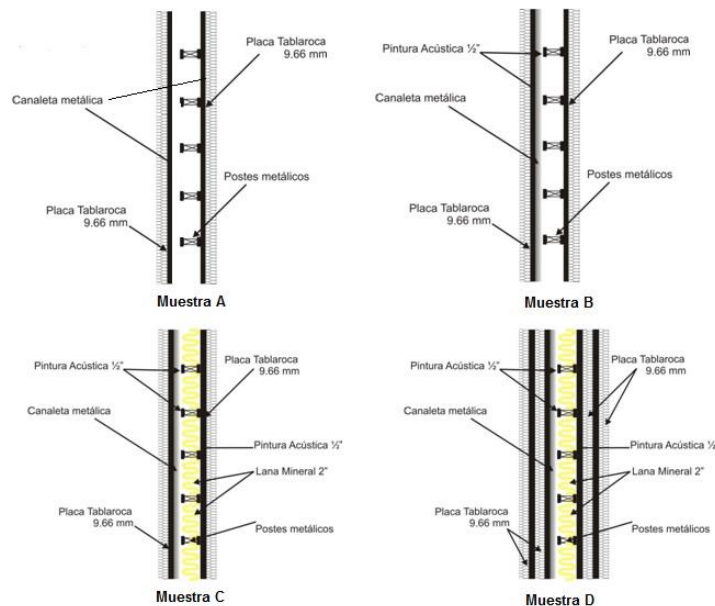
Detalles de ensamblado de las muestras de paneles acústicos a medir.
